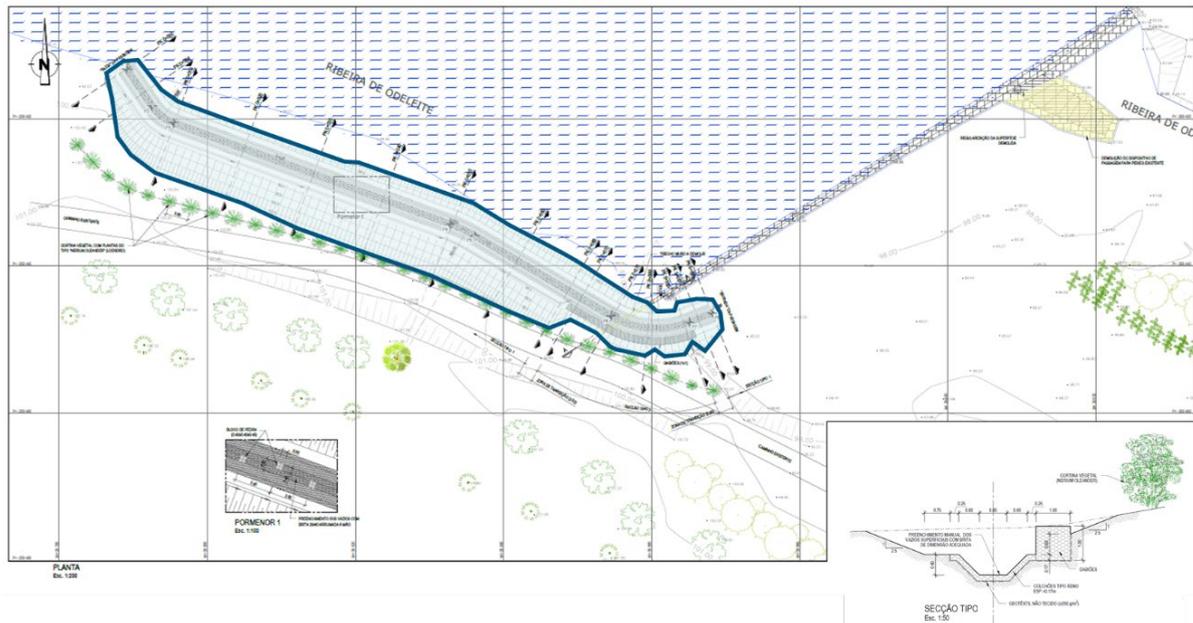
Canal naturalizado ou *bypass* (projeto AQUALOGUS).
